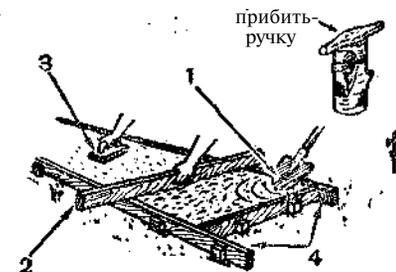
Укладка бетонной массы в опалубку: 1, 2 и 3 — последовательность операции; 4 — опалубка
